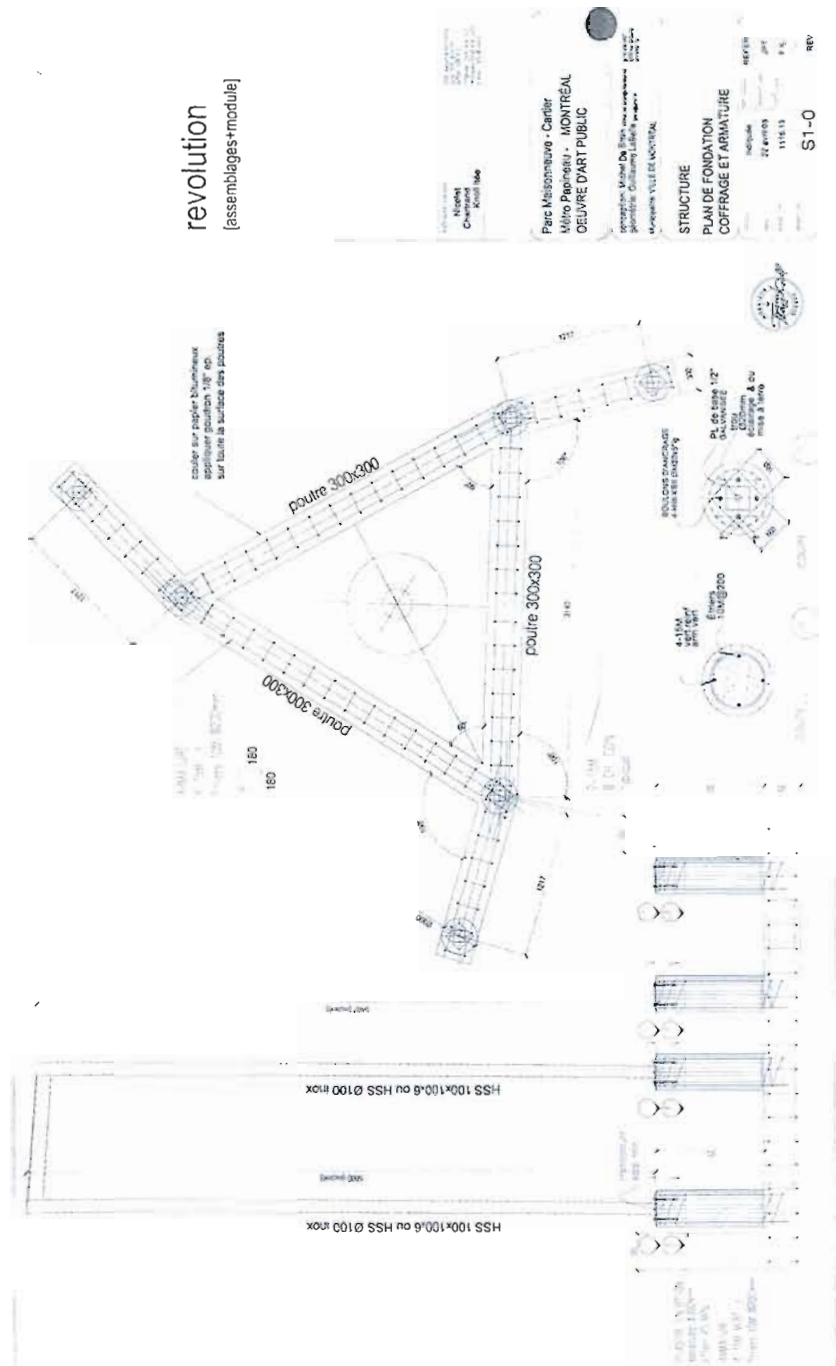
14 Plan réalisé par la firme d'ingénieurs-conseils Nicolet, Chartrand, Knoll, Ltée, pour la structure, le plan de fondation, coffrage et armature, le 22 avril 2003. Conservée au Bureau d'art public.
